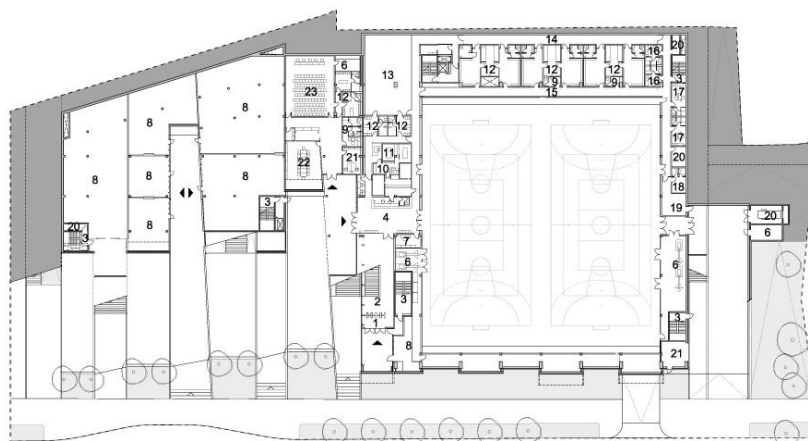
Lapangan Futsal dan Basket Center Pantai Panjang Bengkulu
